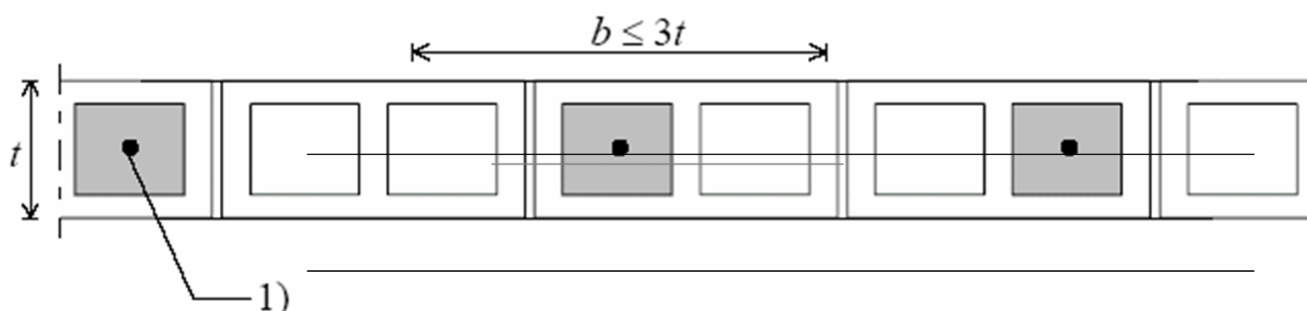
Ширина перерізу для елементів з локально розташованим армуванням
